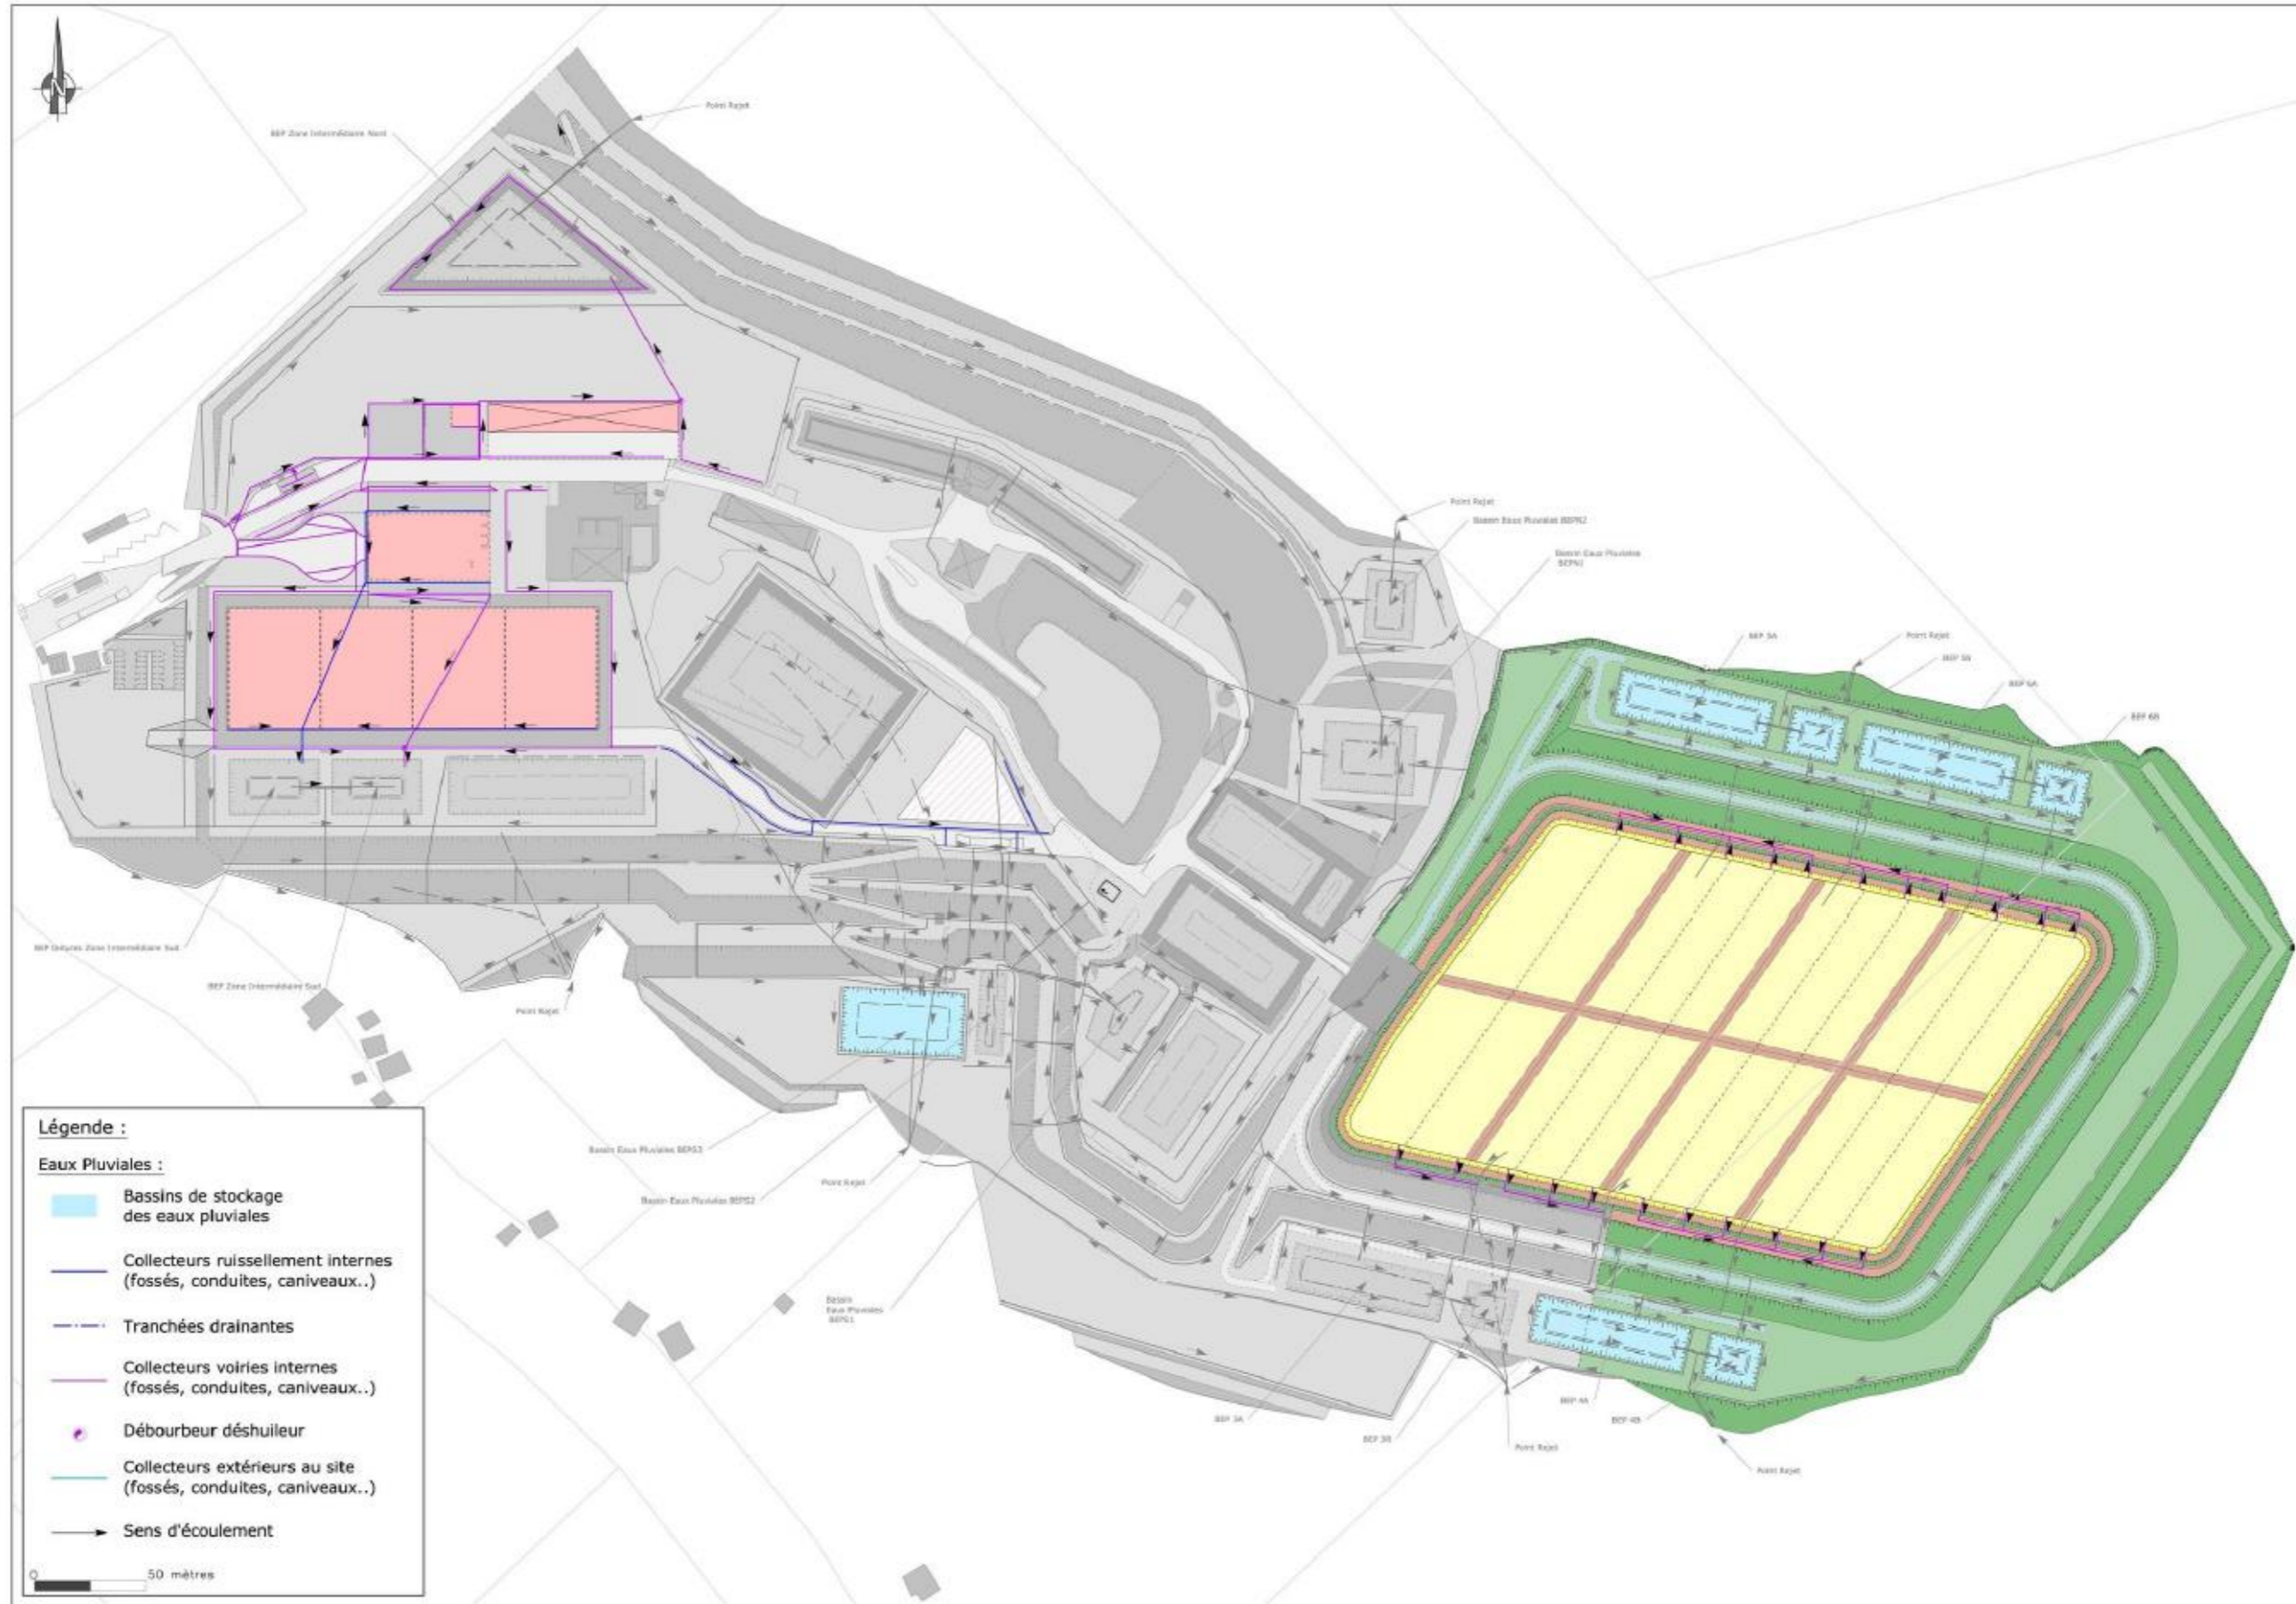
Plan de la gestion des eaux niveau 2 (Source : BETA Environnement)
